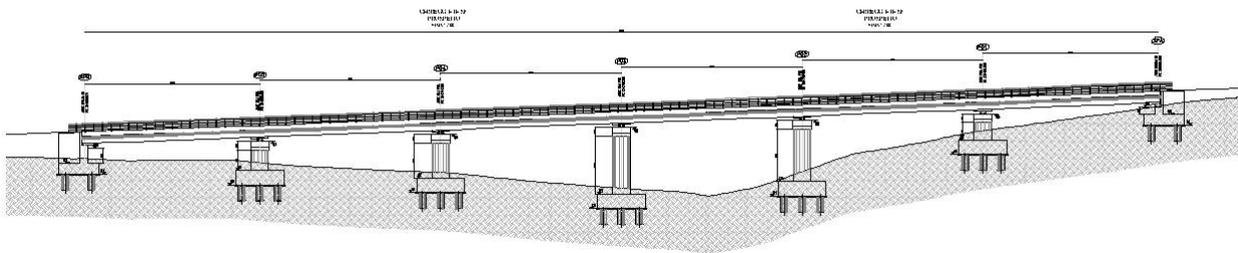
Prospetto carreggiata SX - Progetto Esecutivo.
